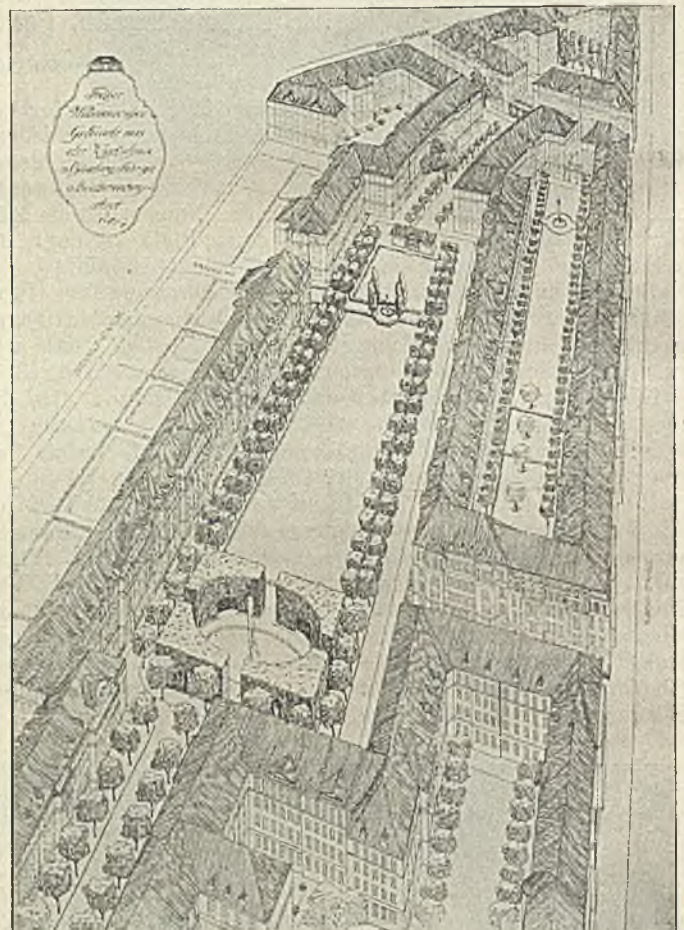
Berlin-Schöneberg. Block mit Innegrünplatz
